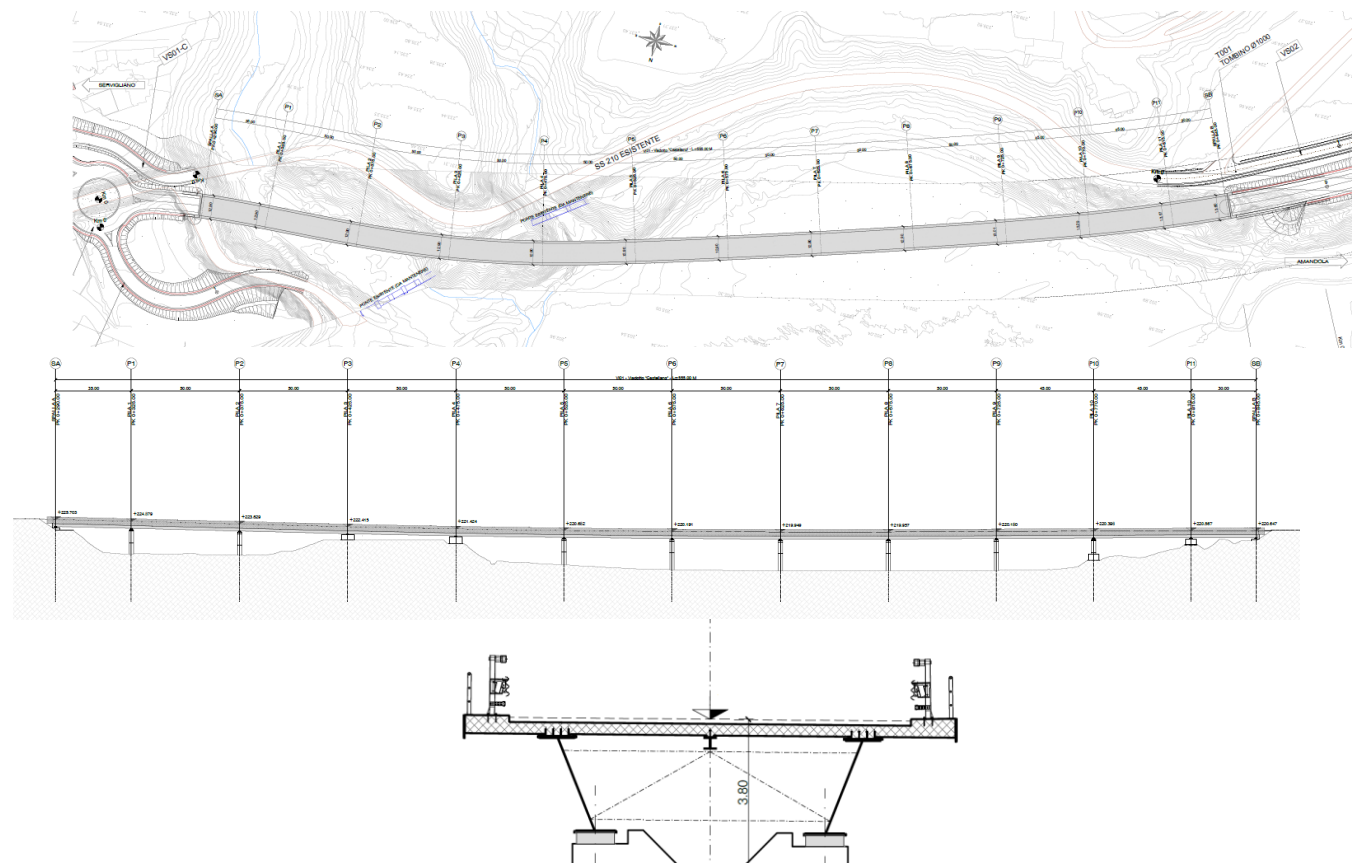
Planimetria, prospetto longitudinale e sezione trasversale dell'opera VI01
